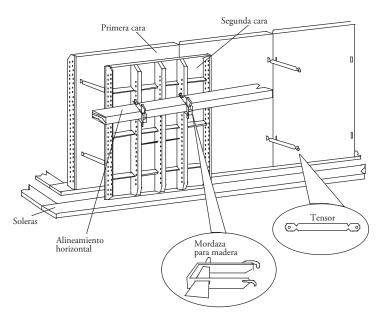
Moldaje EFCO para muros, montaje de segunda cara y esquemas de uniones entre caras.
